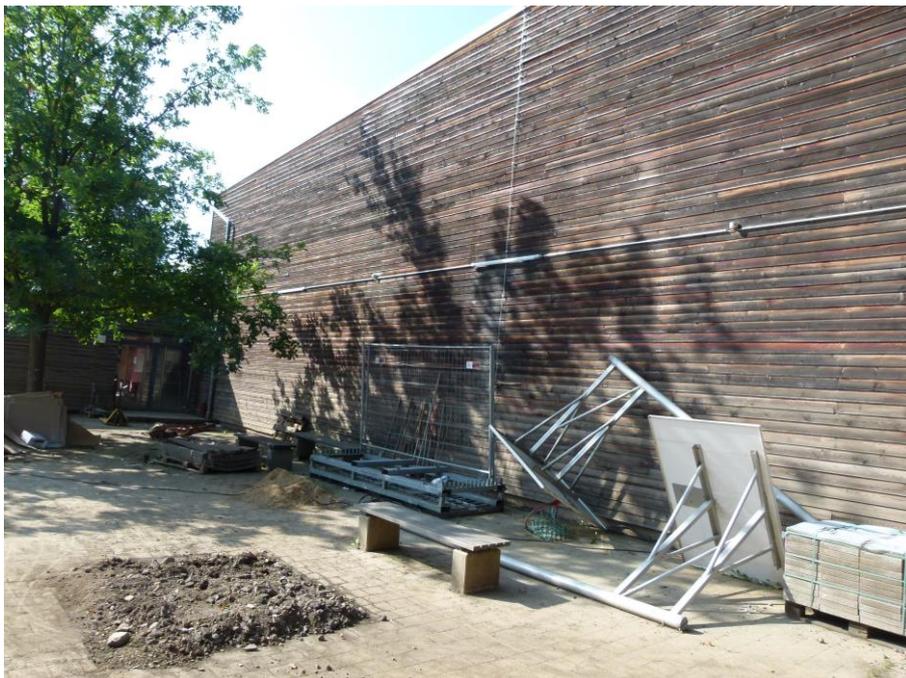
Sporthalle / Ostfassade mit Blick Richtung Süden
